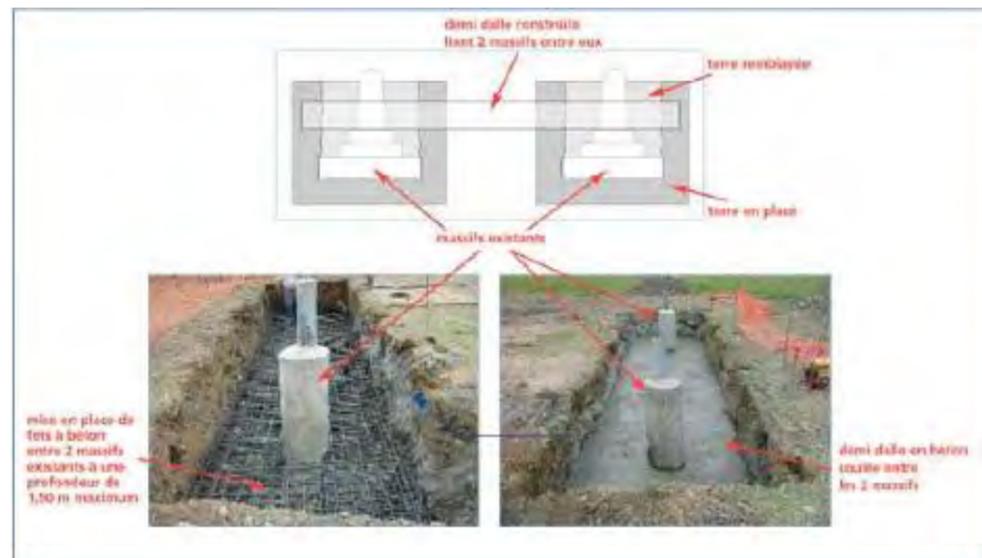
Renforcement des fondations par la technique des demi-dalles (RTE, 2016)
